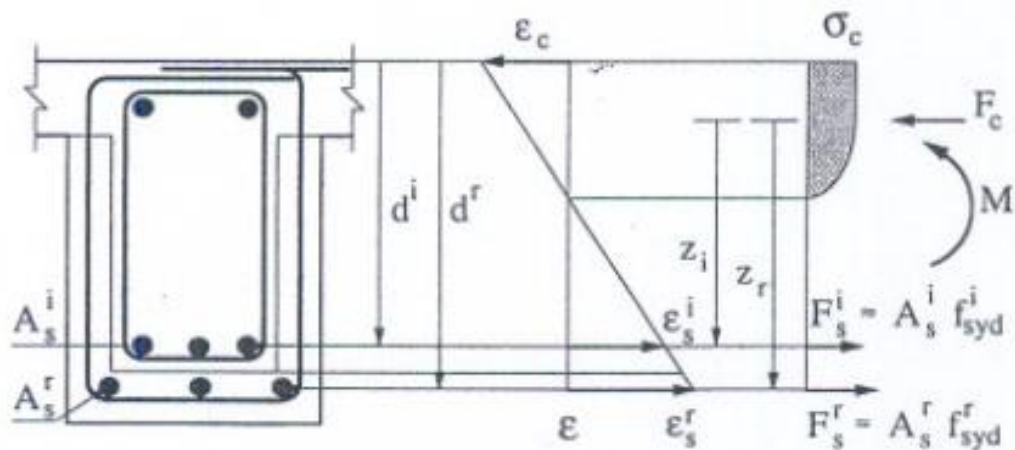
Modelo de cálculo à flexão de vigas reforçadas por encamisamento de betão armado (Gomes, A., Appleton, J.)
